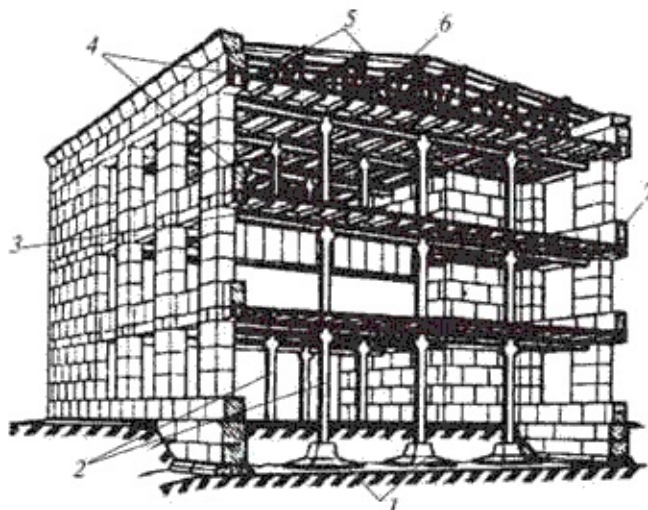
Многоэтажное каркасное здание с балочными перекрытиями:
